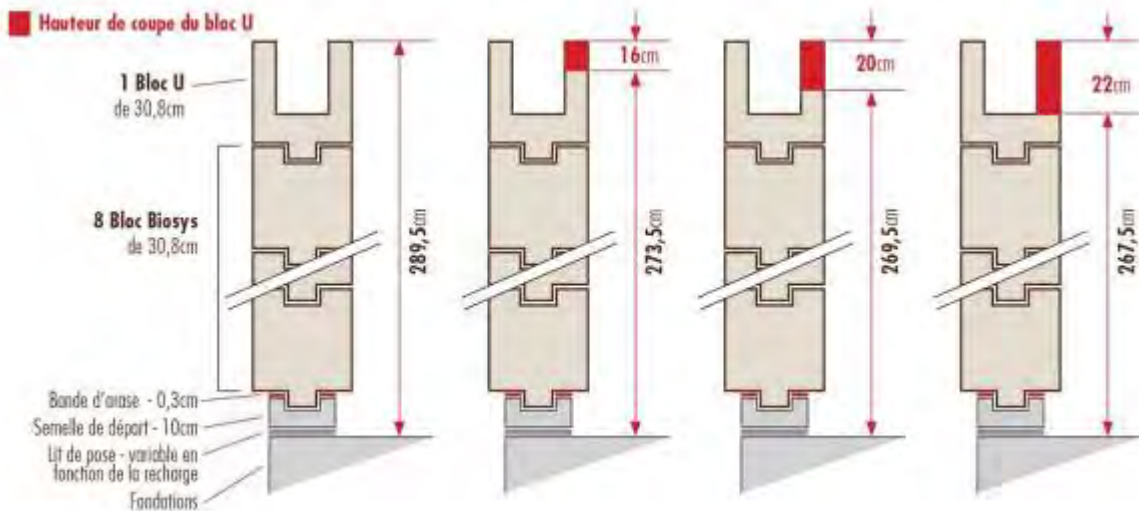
calepinages des hauteurs entre dalle brute et sous-face de plancher
